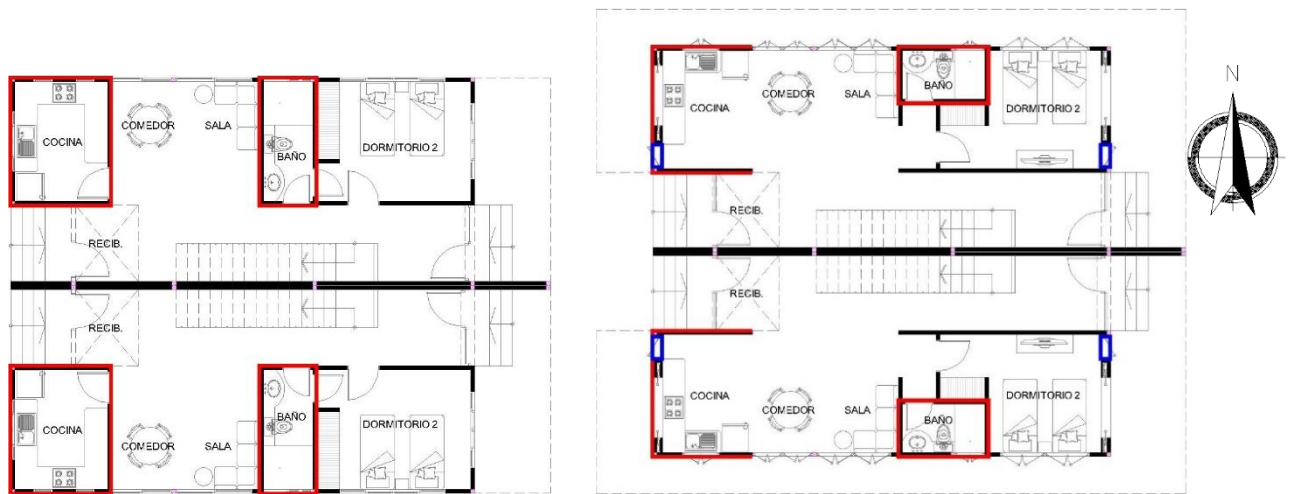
Cambios de planta baja de proyecto base a proyecto modificado.
